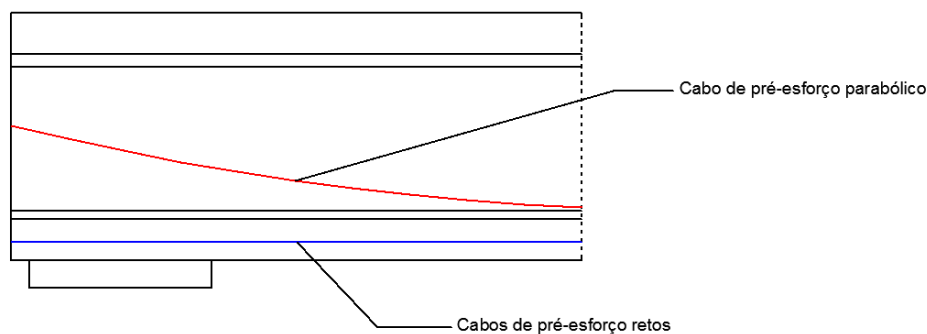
Modelo esquemático da viga de betão armado pré-esforçada com a disposição dos traçados longitudinais reto e parabólico.
